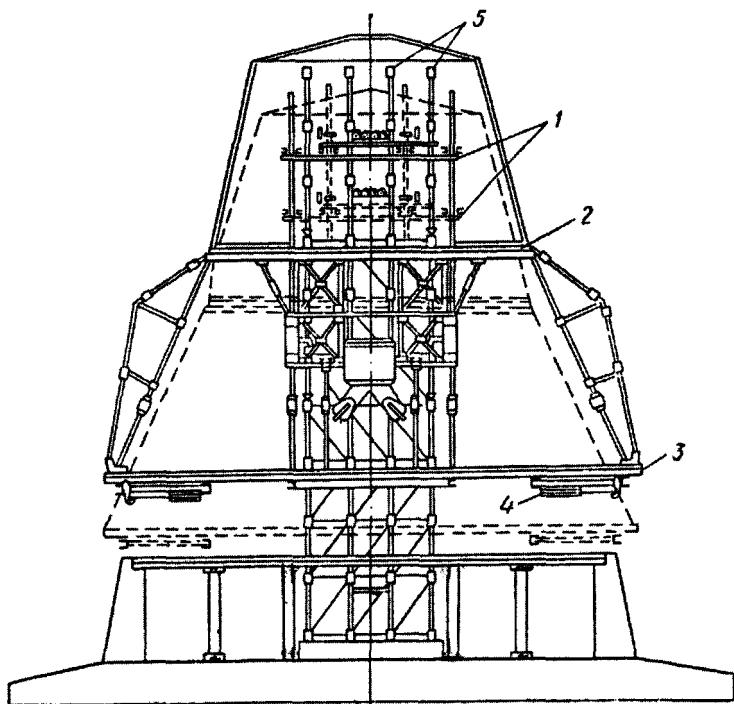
Положение подъемника после его испытания перед монтажом опалубки: 1 — опорная переставная рама; 2 — монтажная площадка; 3 — рабочая площадка; 4 — механизм радиального перемещения наружной опалубки; 5 — стойки шахтного подъемника
